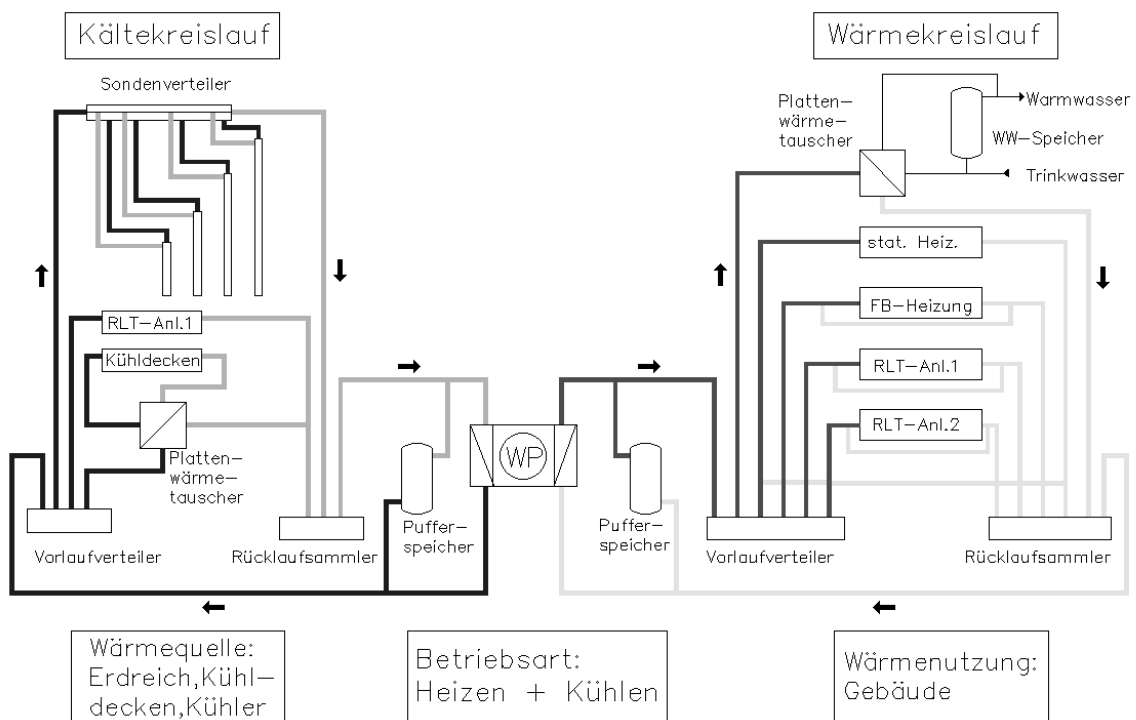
Funktionsschema Heizung und Kühlung [13].
